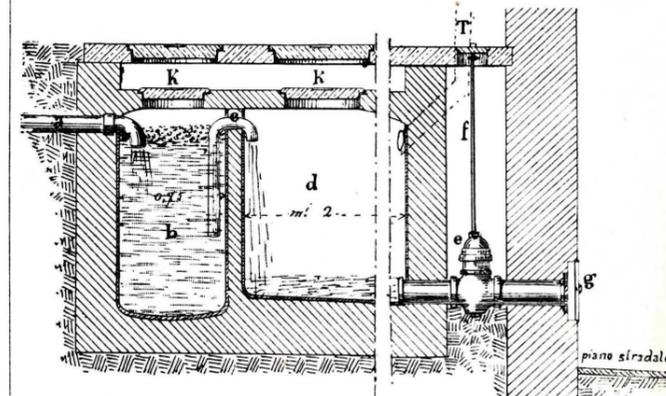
FIG. H. — Pozzo nero o fossa diluente Mouras (Sezione longitudinale e pianta).
